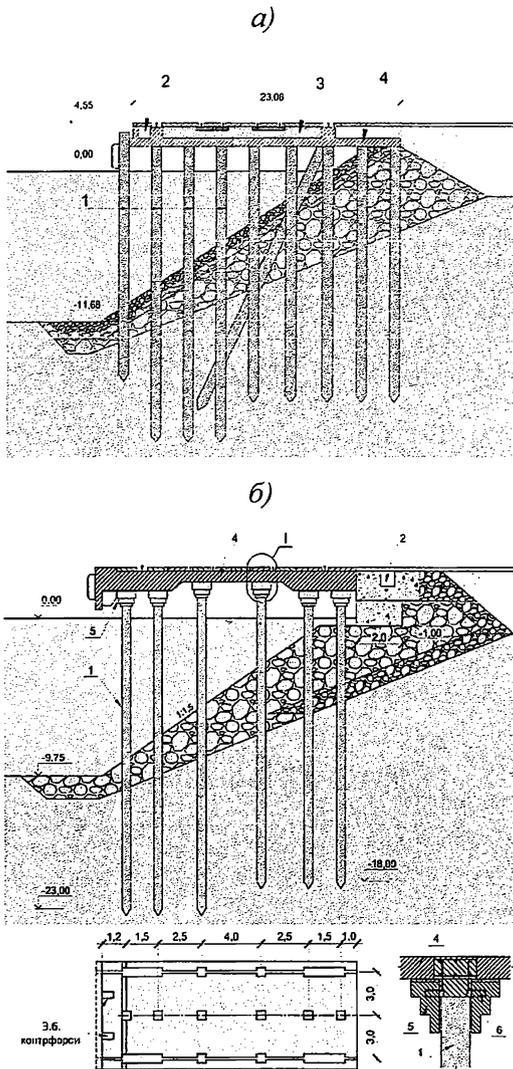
Набережні-естакади із залізобетону з монолітною (а) і збірною (б) верхньою будовою:
